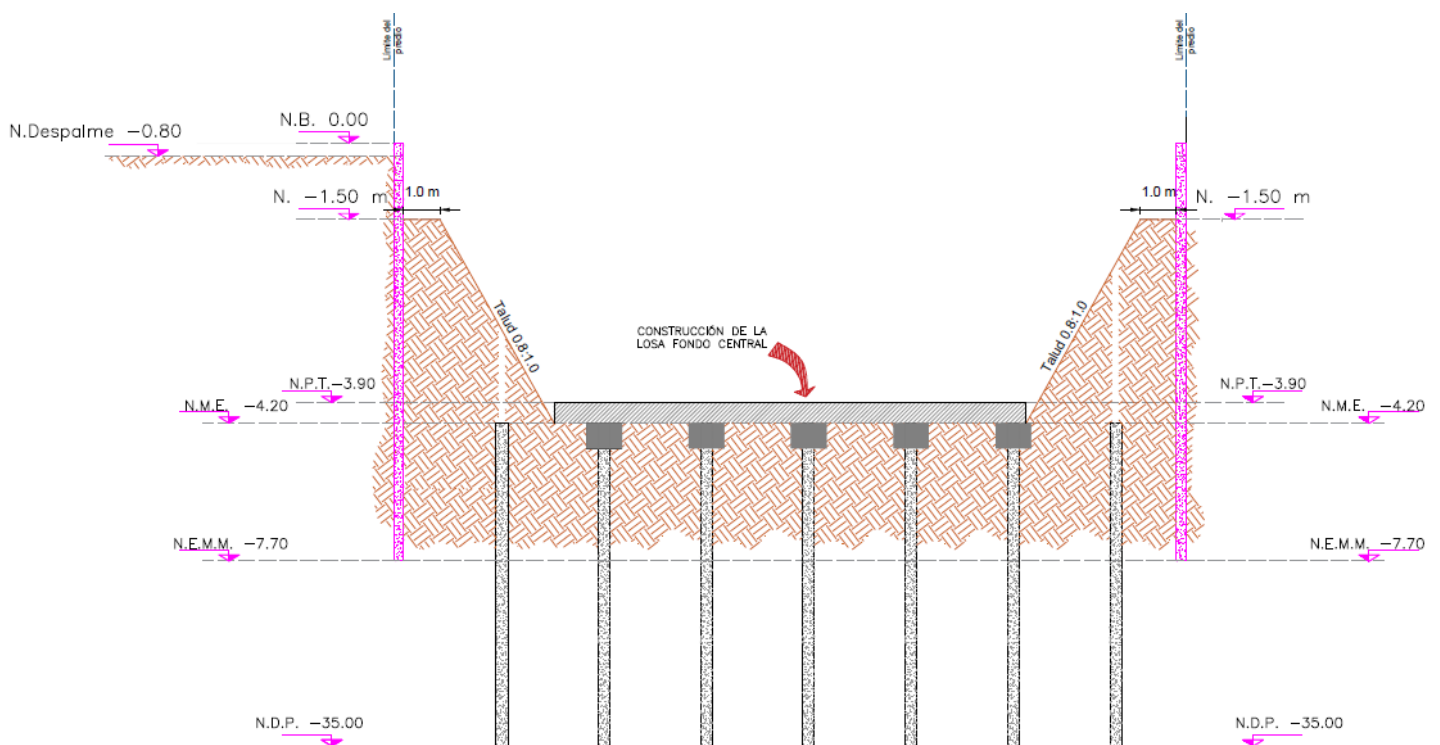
CONSTRUCCIÓN DE LA LOSA CENTRAL
